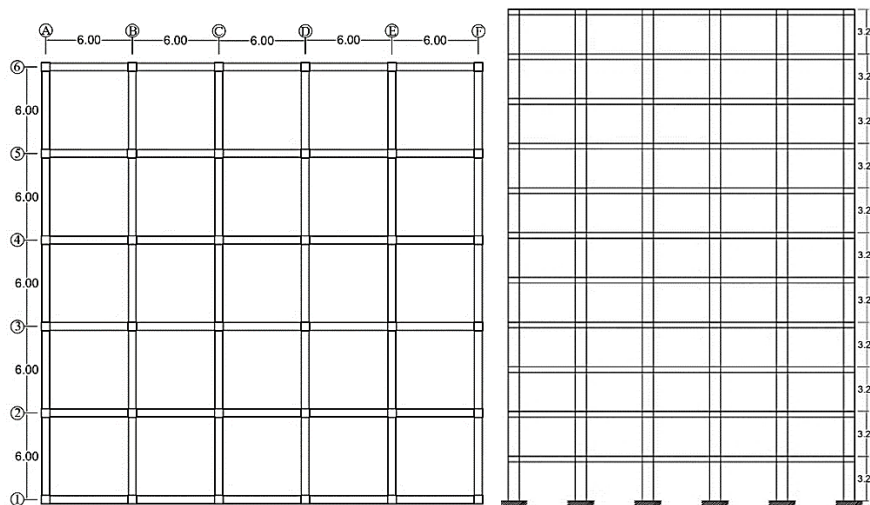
Estructura aporticada de gran altura (vista en planta y elevación)
